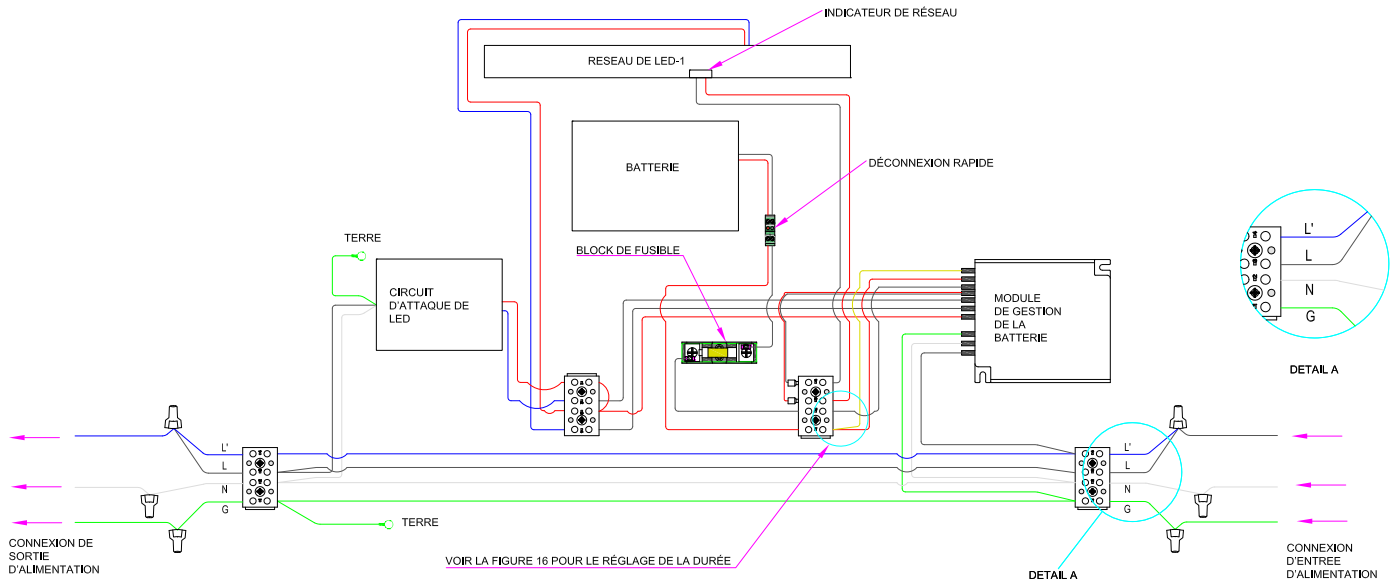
C: CABLAGE D'ALIMENTATION CONTINUE, DISPOSITION DE CONNEXION A 3 FILS AVEC ECROUS DE FIL: 2 PIEDS
